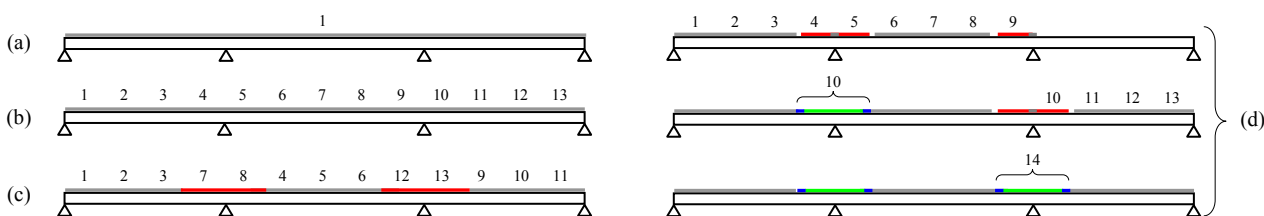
Schemi di getto: (a) getto unico; (b) getto in avanzamento; (c) getto alternato campata-appoggio della soletta; (d) getto in avanzamento con soletta post-connessa
